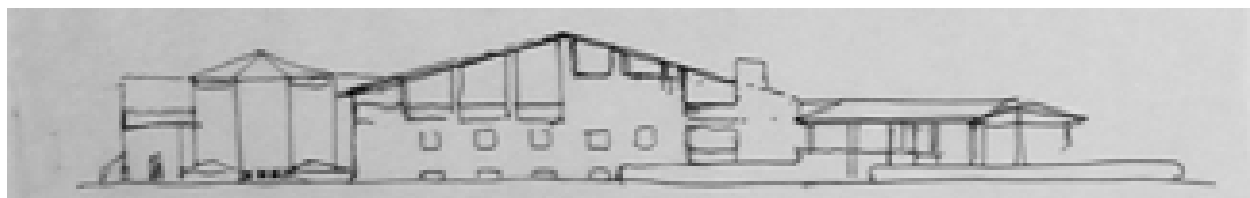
Prospetto, stato futuro – 09/11/1993 (AABS-64_262)
